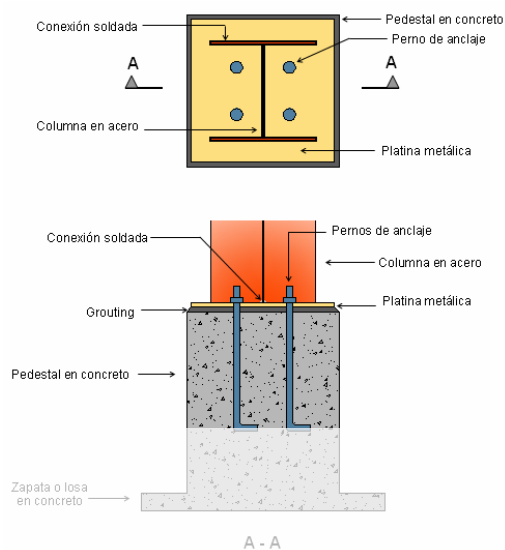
Sistema de conexión columna-fundación y sus componentes.
